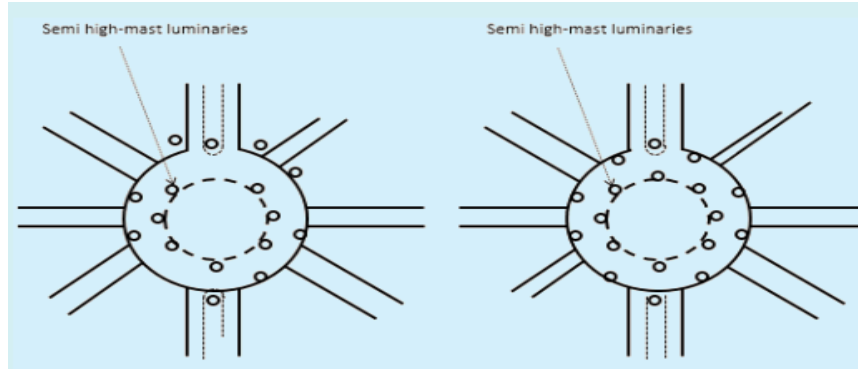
वर्तुळ चौकासाठी लाइटिंग लेआउट: भूपृष्ठ जे बागा किंवा इतर बांधकाम असलेले आहेत जे वाहतुकीच्या दृष्टीच्या रेषेवर अडथळा निर्माण करू शकतात (Lighting layout for Roundabouts: Islands which have gardens or other construction which would be obstruction to line of vision of traffic)
